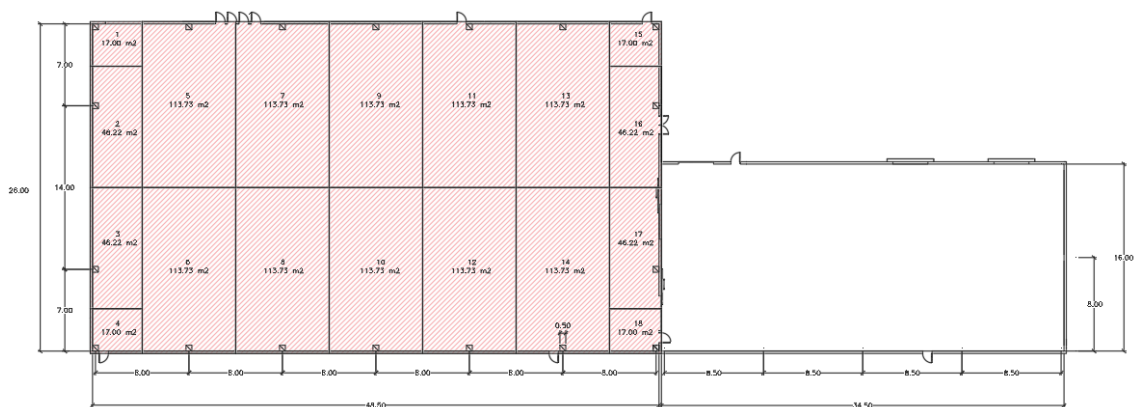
Disposició pilars magatzem (Cotes amb Metres). Font: Elaboració pròpia
